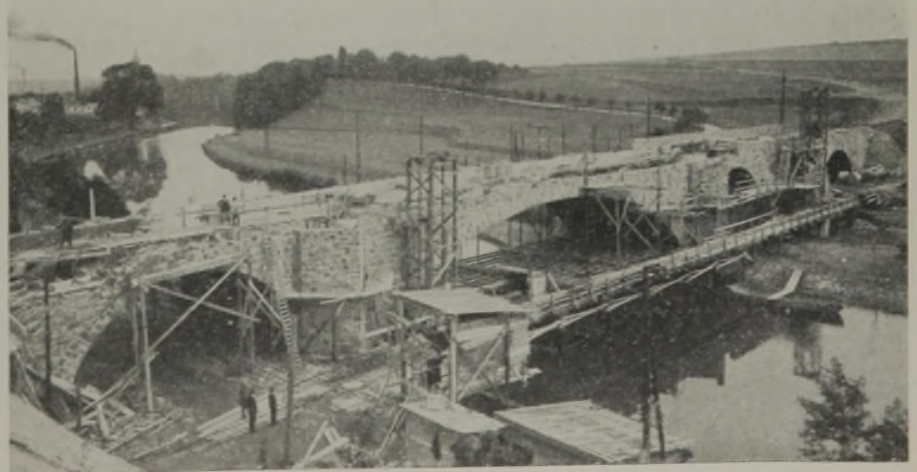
Muldenbrücke im Bau mit Baustelleneinrichtung.
